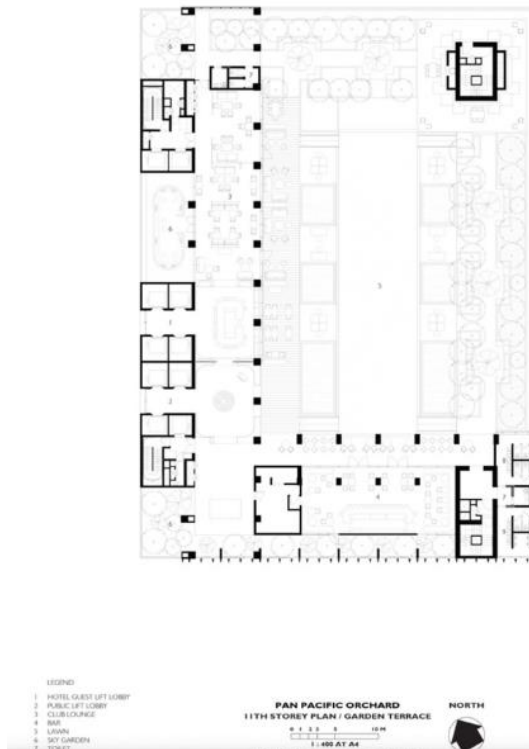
План Садова тераса 11-го поверху (готель Pan Pacific Orchard) [1]
